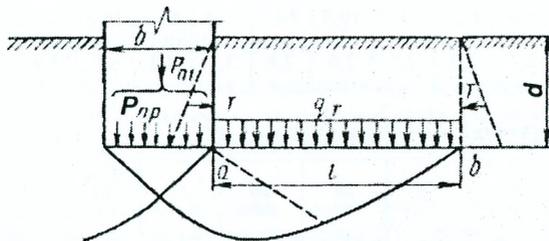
Схема для определения предельного давления на предварительно уплотненное основание фундамента глубокого заложения (формула 7.1)
